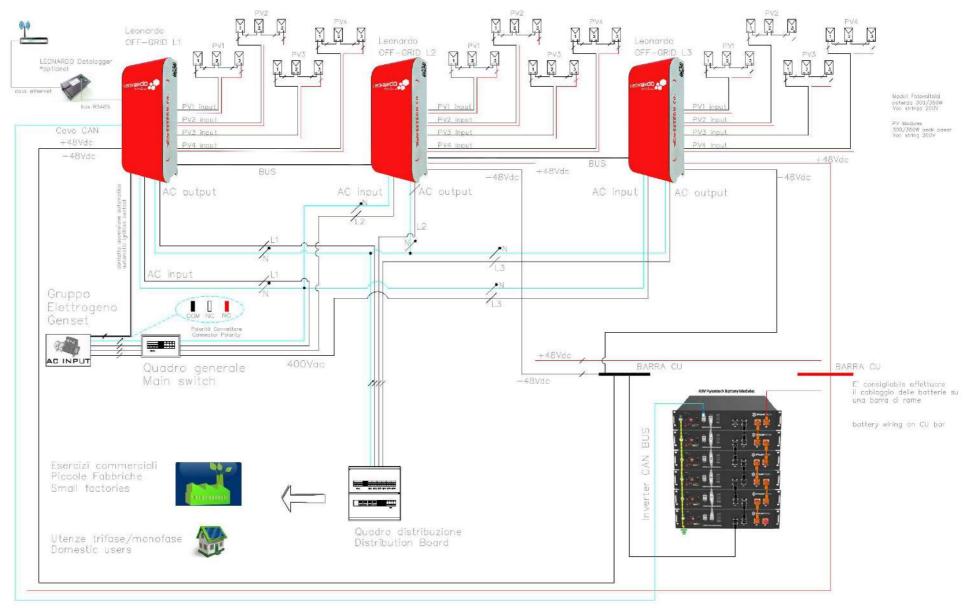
Schema Unifilare dell'impianto trifase 9Kw
